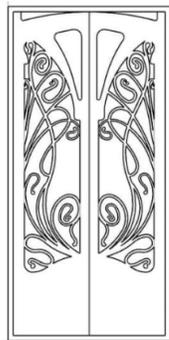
(2023). Herrería en puerta en planta baja. [Sketchup].
